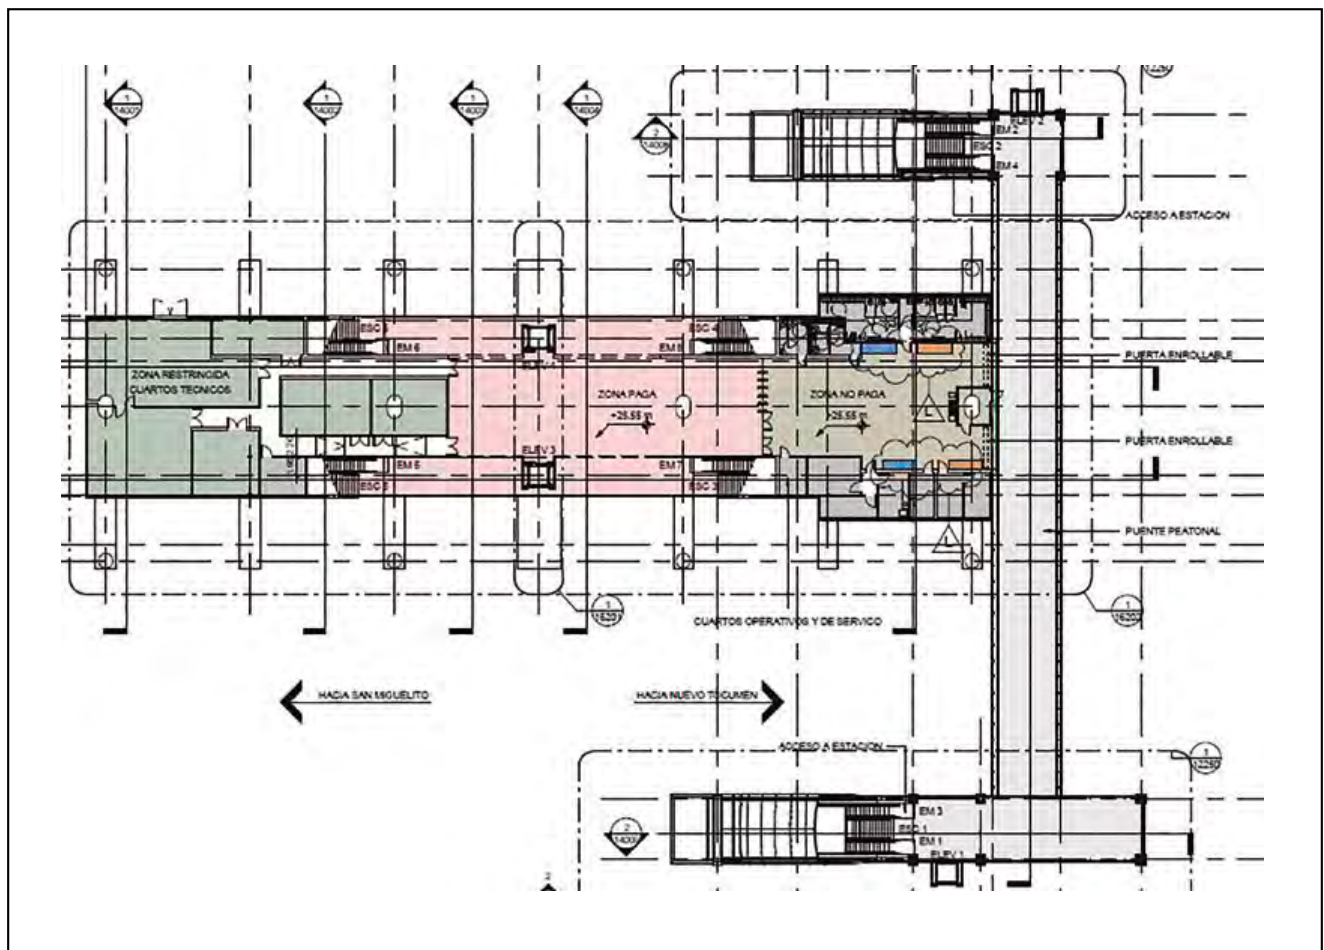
Estación Corredor Sur – Vista en planta del nivel vestíbulo.
